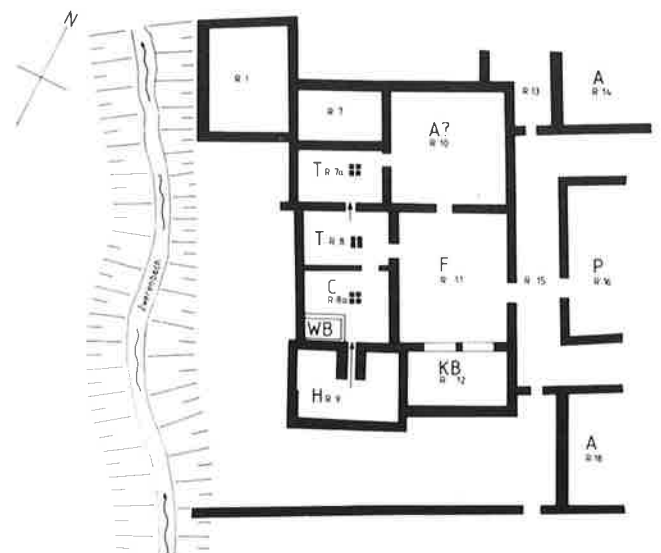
Bauphase 4; schematischer Grundriss
